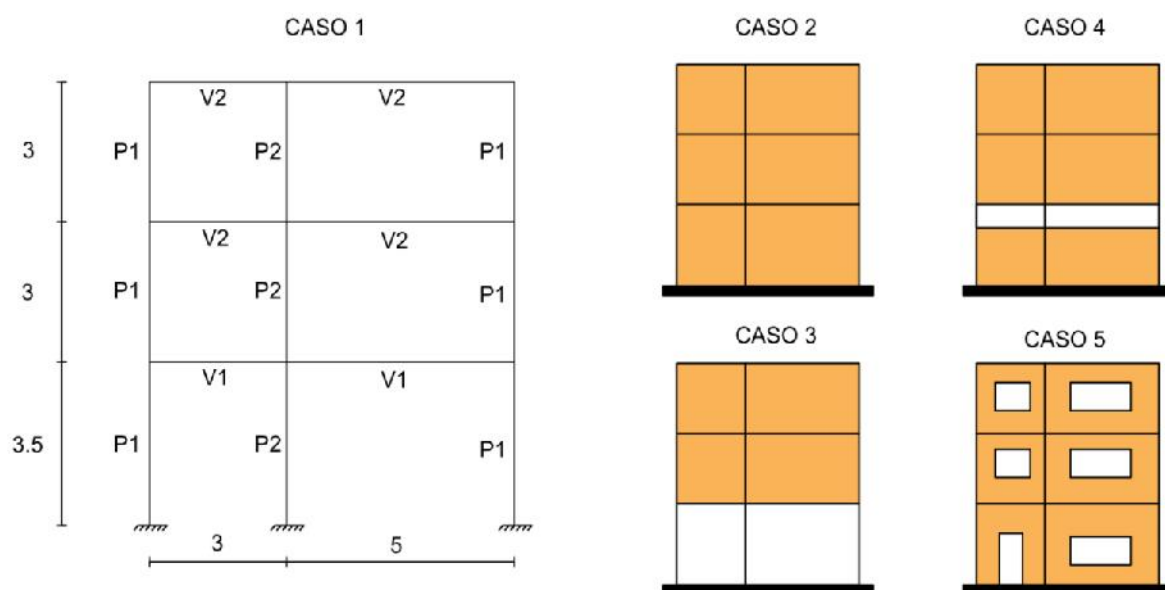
Pórticos do estudo (adaptado Estêvão e Oliveira, 2014).
